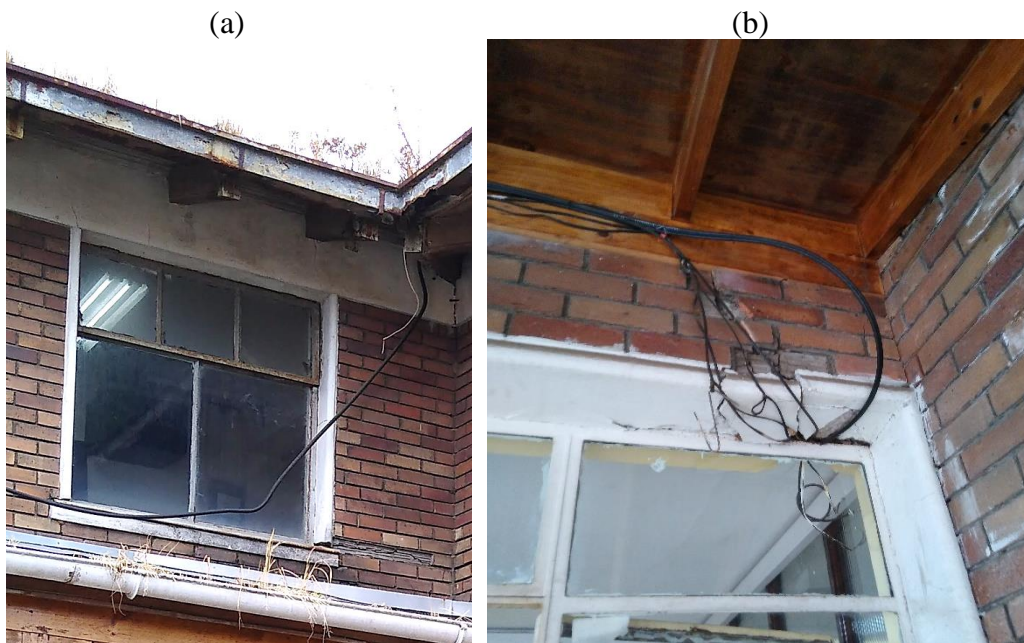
4 Grietas elevación DIDECO eje 4: (a) y (b) de Fig. A.4.5.1.6(a).
